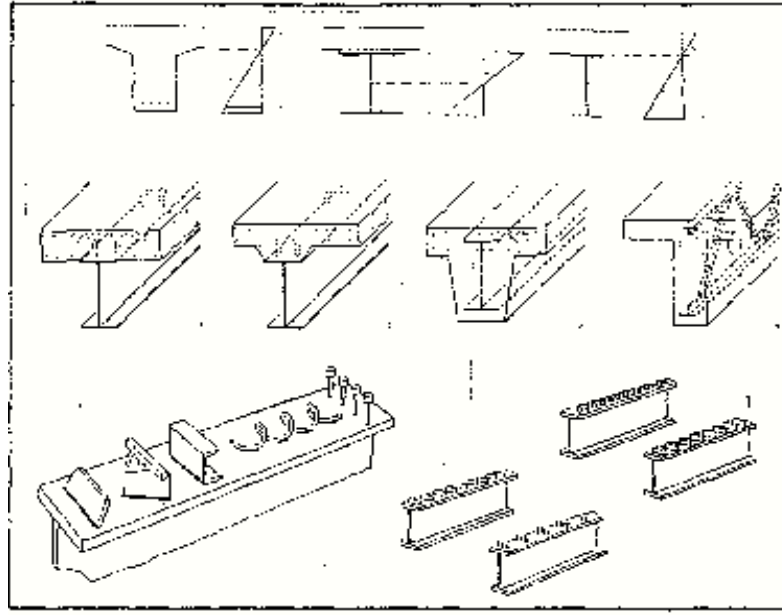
Çelik kiriş üzerinde bulunan kesme elemanı (stud).
